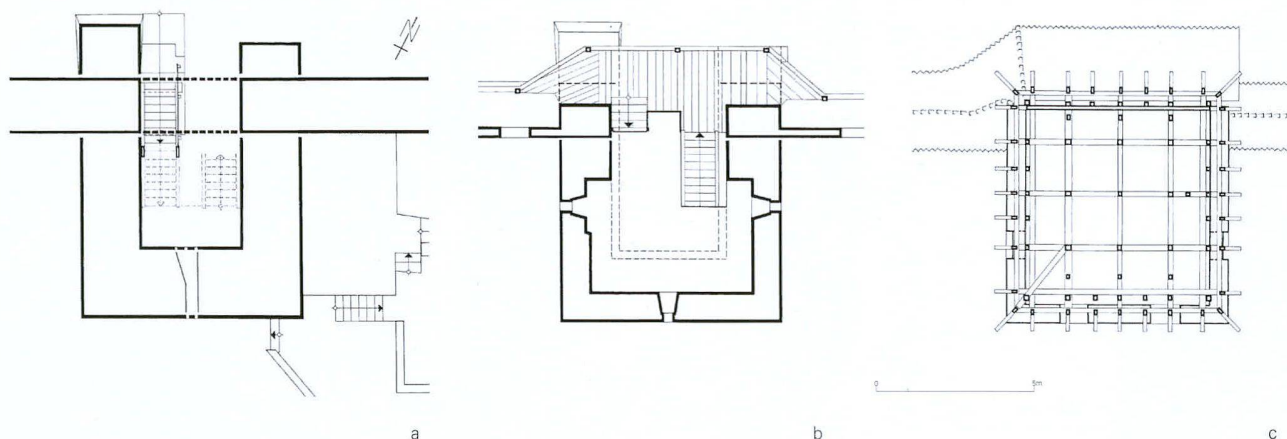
Grundrisse des Erdgeschosses (a), des Turmggeschosses (b) und des Dachwerks (c) (aus Schöpfer 2000, Abb. 418)
